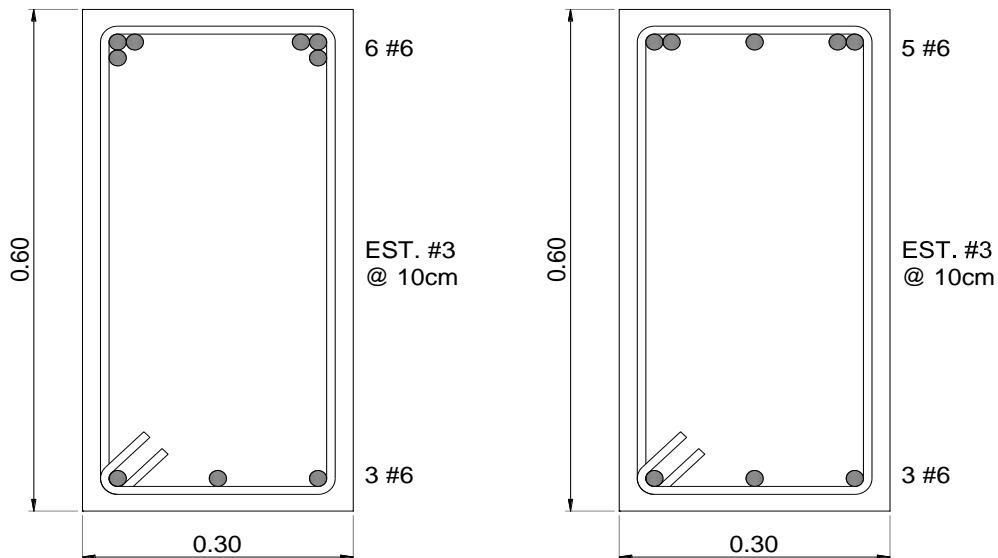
Armado de travesaños; izquierda primer nivel, derecha segundo a cuarto nivel, para el edificio de siete niveles en su primer etapa de construcción
